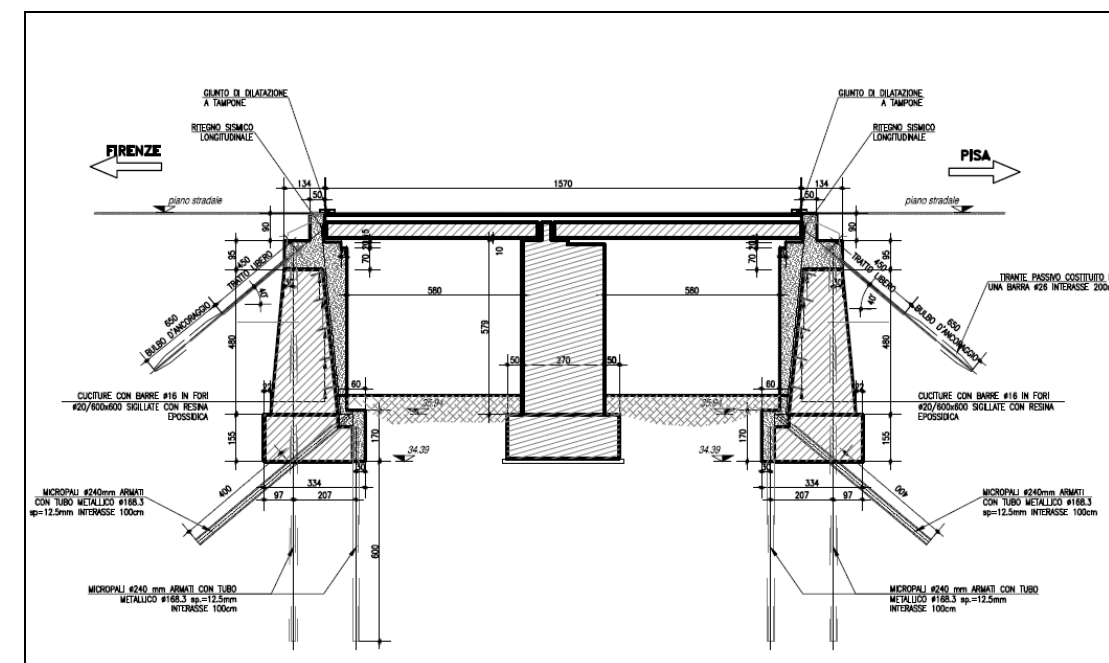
Sottovia S.C. Cantone. Sezione longitudinale
